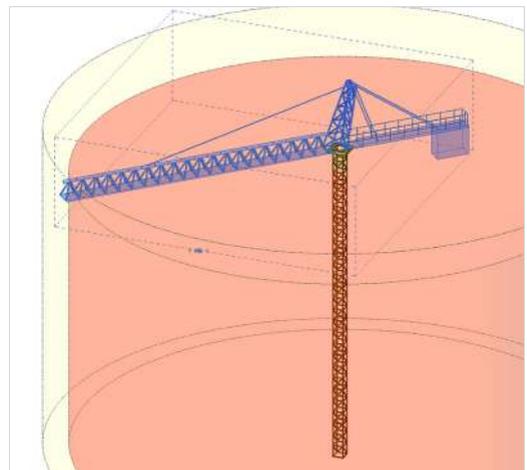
Modelado Áreas de barrido y de trabajo en grúas en familias en Revit. Revit. Elaboración propia
